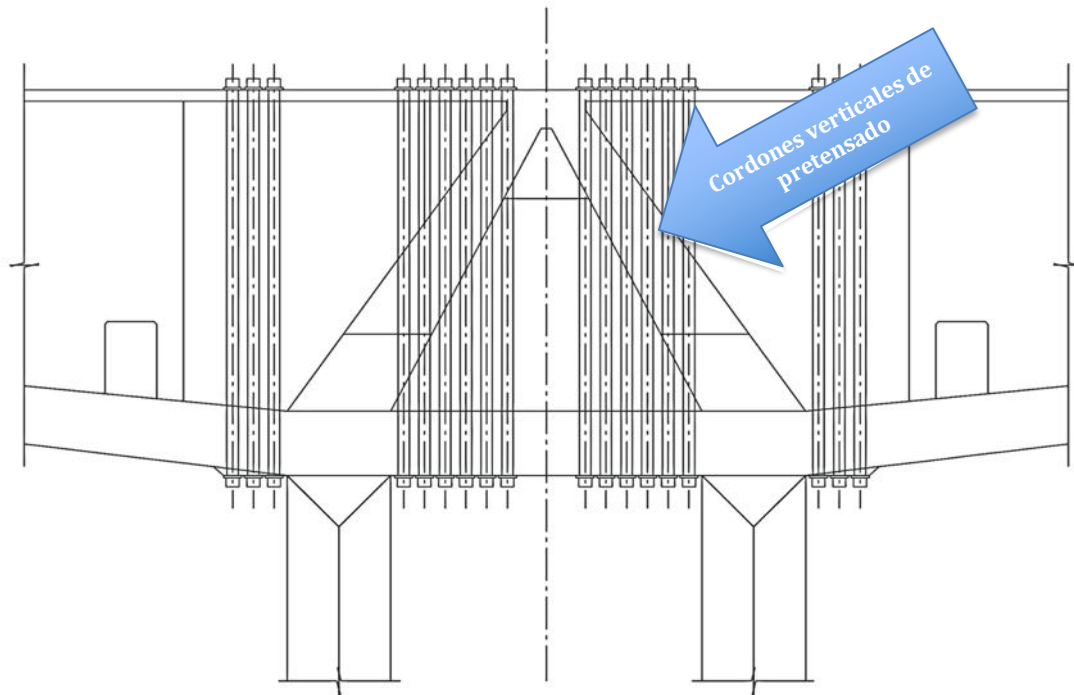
Pretensado vertical en los diafragmas, en el encuentro entre las pilas y el cajón debido al debilitamiento de la zona por el pretensado exterior.
